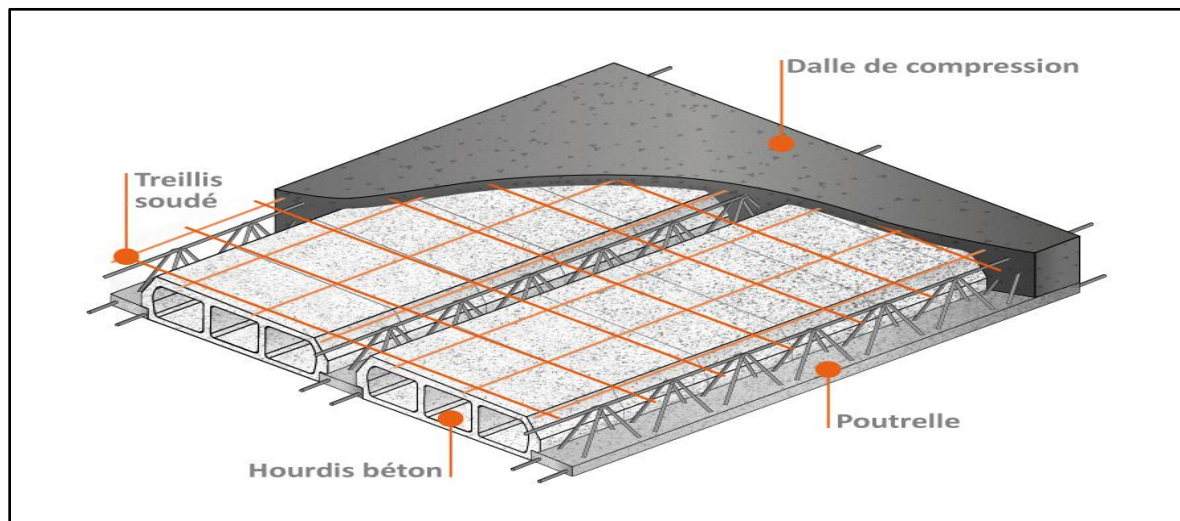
Schéma descriptif d'une dalle à corps creux.
